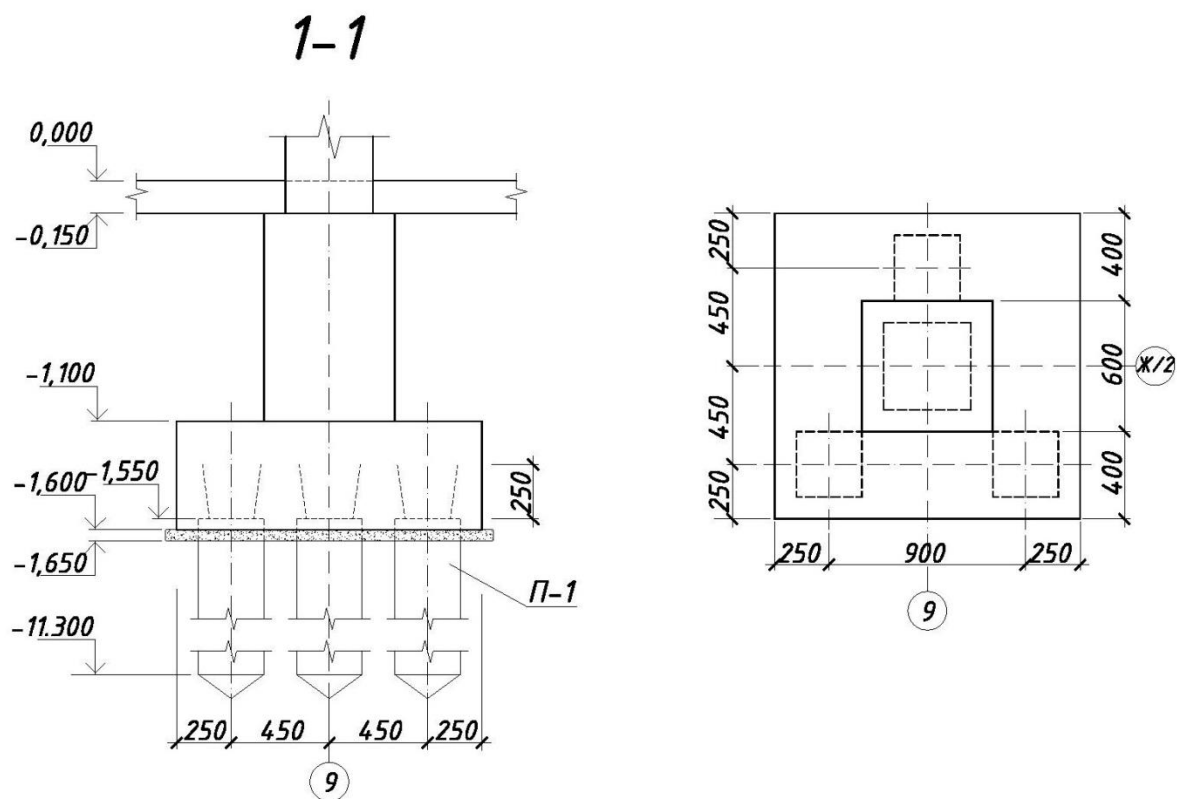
Конструкція стовпчастого фундаменту колони типу КМ-2.3. на перетині осей 9 та Ж/2 (3 палі)
